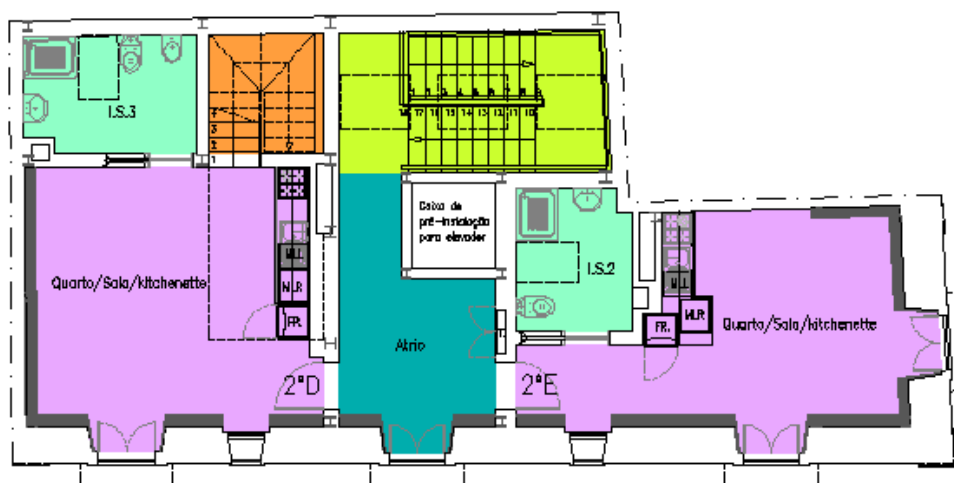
Planta do Piso 2 (Fonte: Projeto de Arquitetura)
